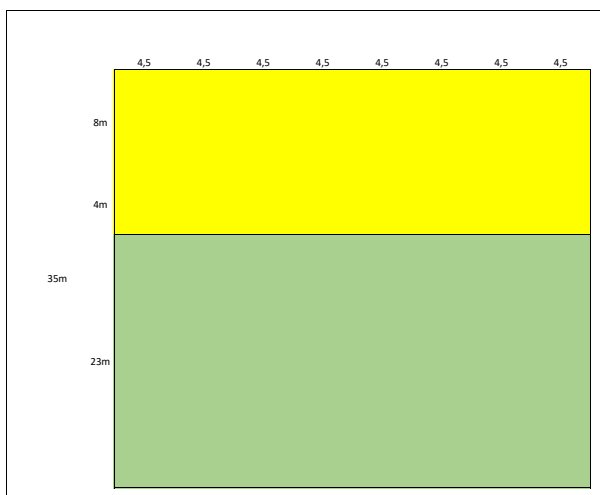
schematische voorstelling collectieve wooneenheden - bebouwing (geel) en tuin (groen)
